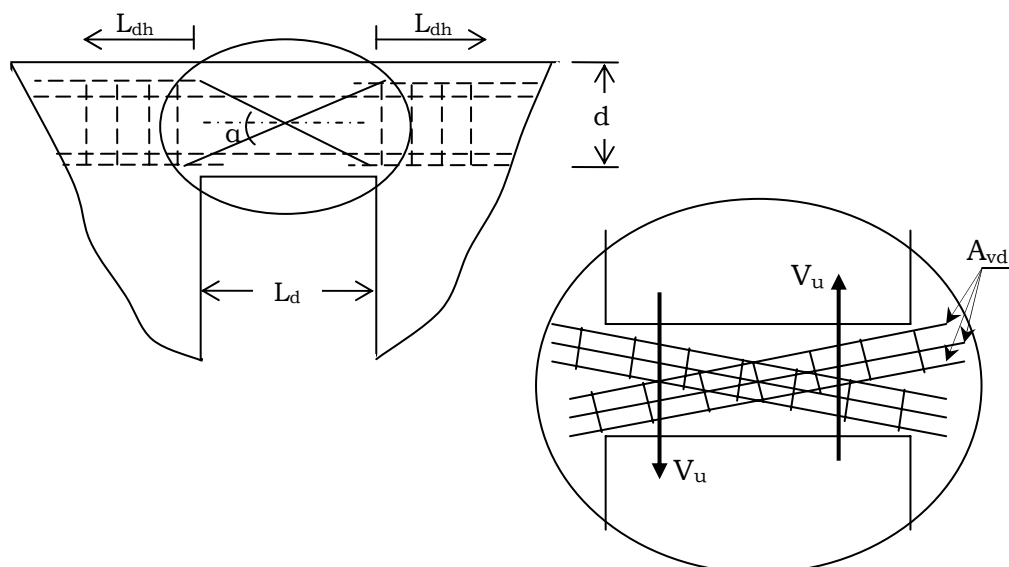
Distribución del Refuerzo en Dinteles de Acoplamiento.
